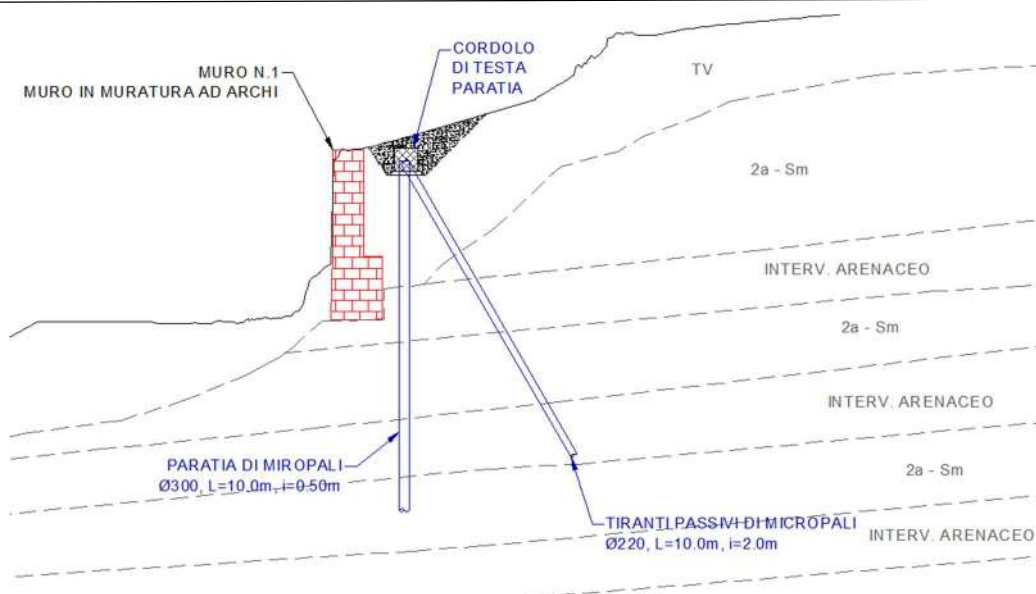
Tratto 1 - Consolidamento muro ad archi in muratura – sezione tipologica di intervento
